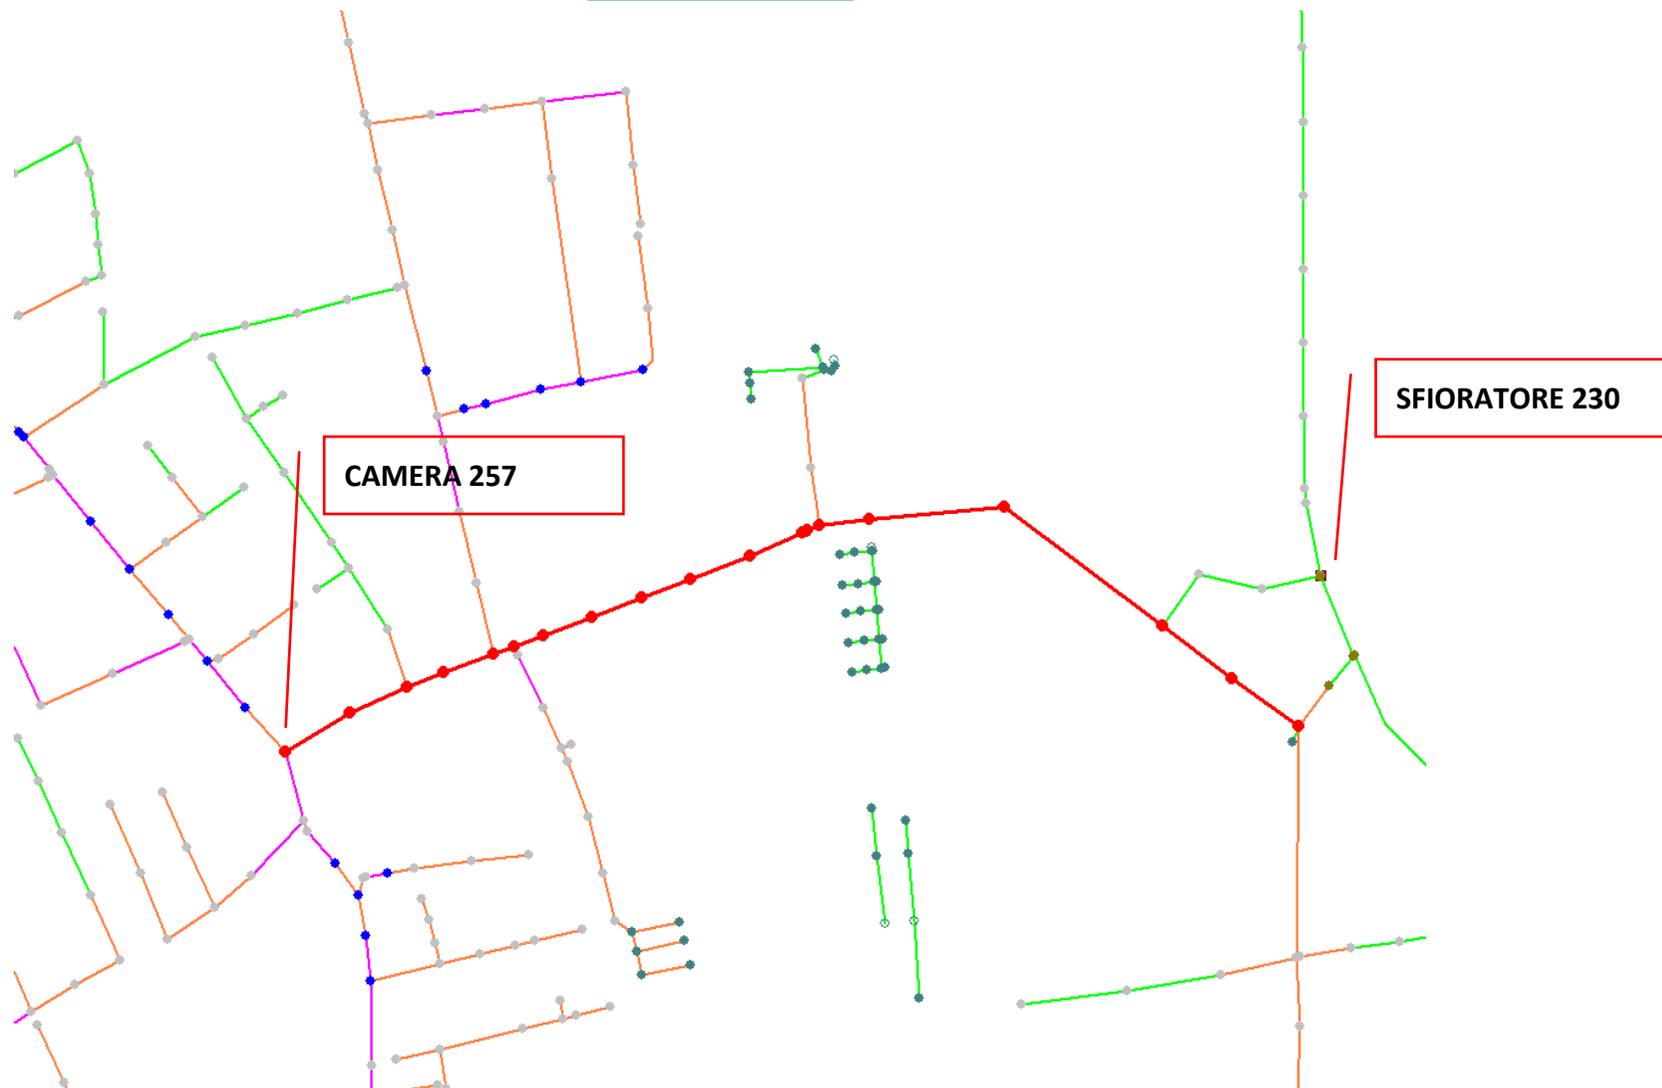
rappresentazione planimetrica del tratto di rete fognaria
